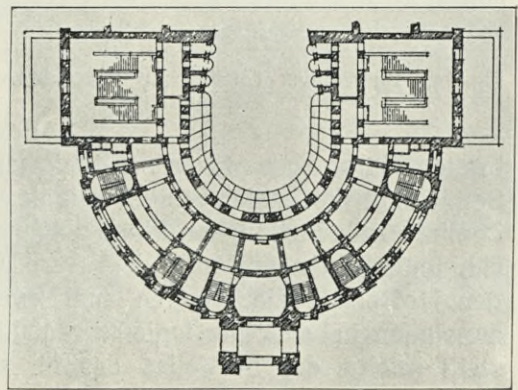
Stadttheater zu Odessa. Grundriß des Zuschauerhauses.<sup>41)</sup>
